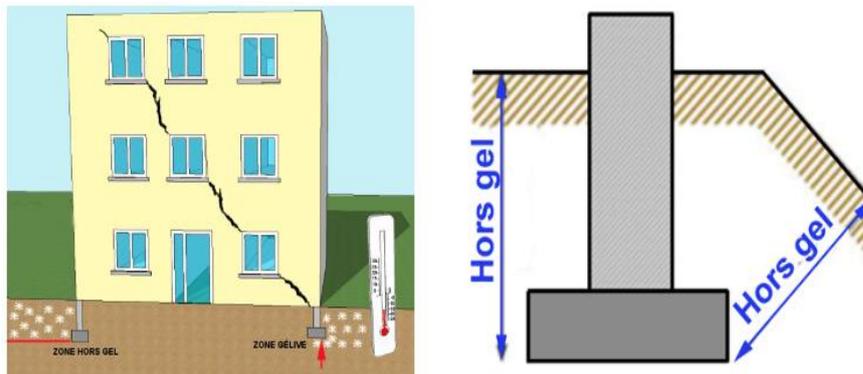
Des fissures inclinées dus au gel des fondations.
